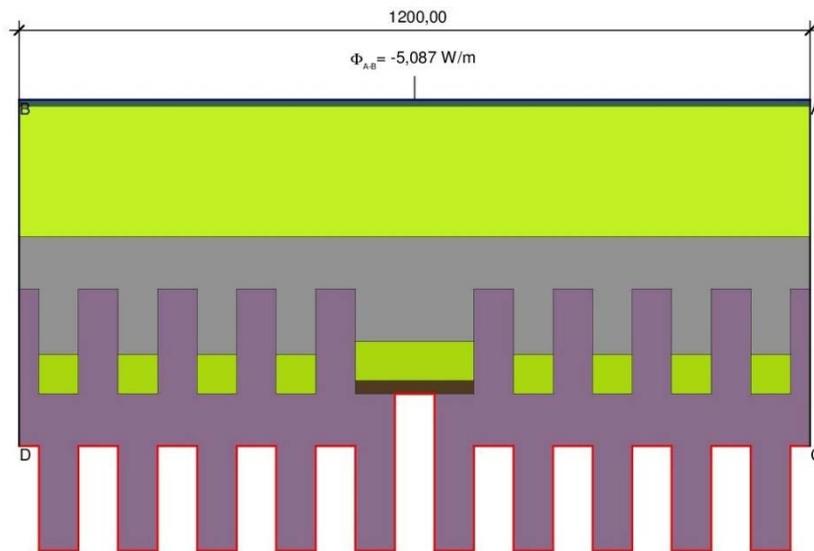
Détail du traitement de joint de dilatation sous dalles sur plots
